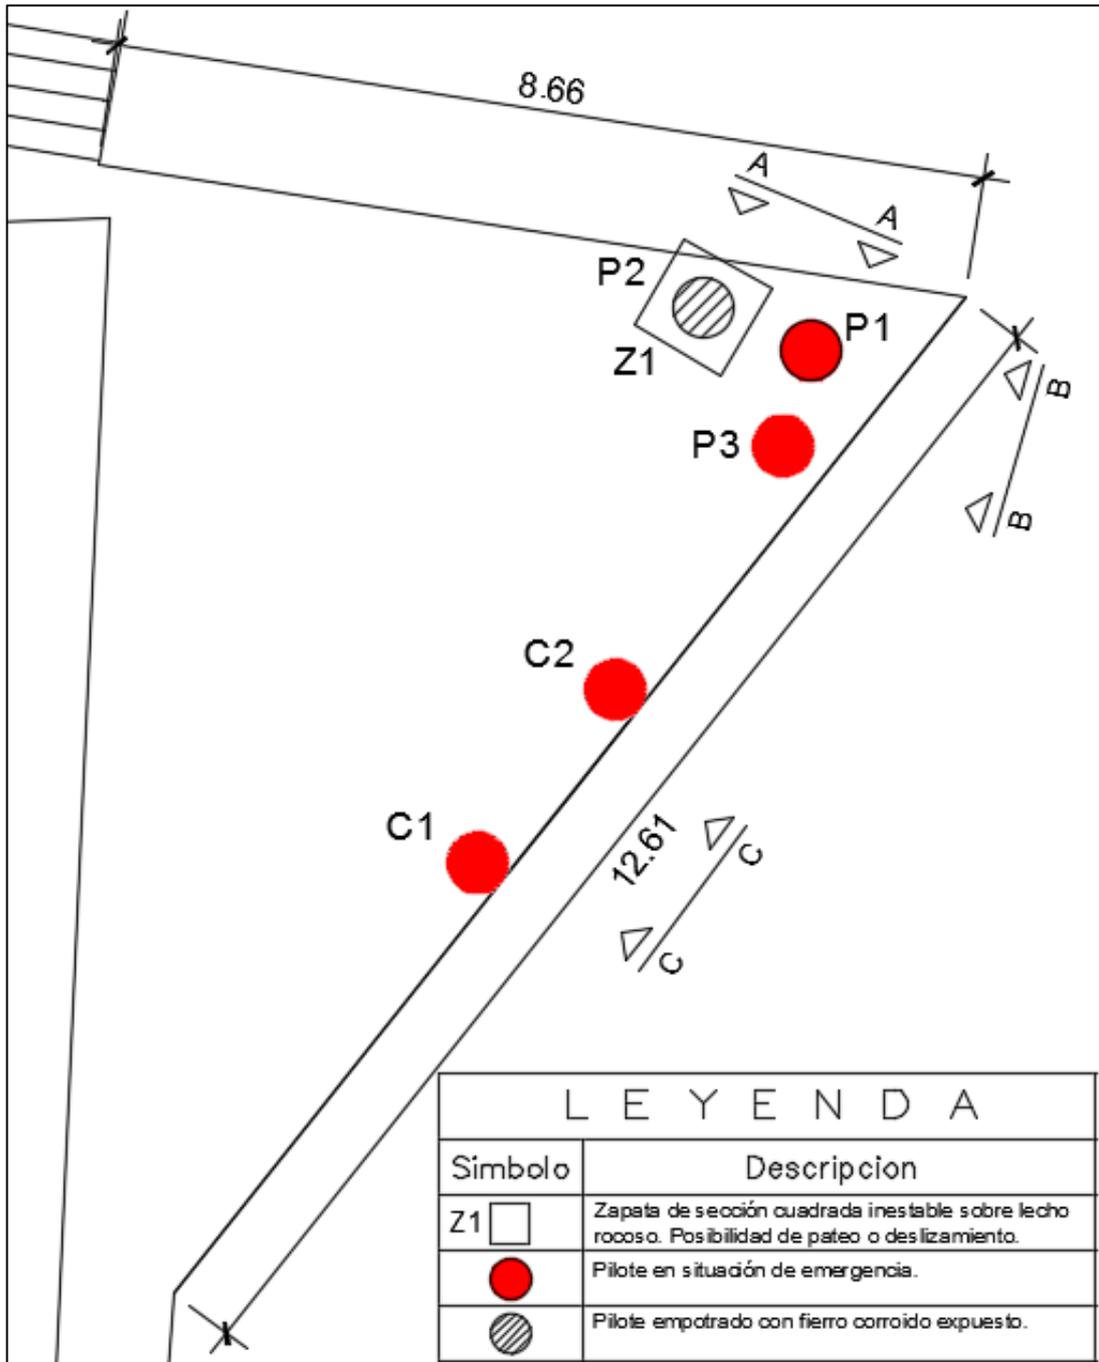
Plano en planta de pilotes de la plataforma "Punta"
